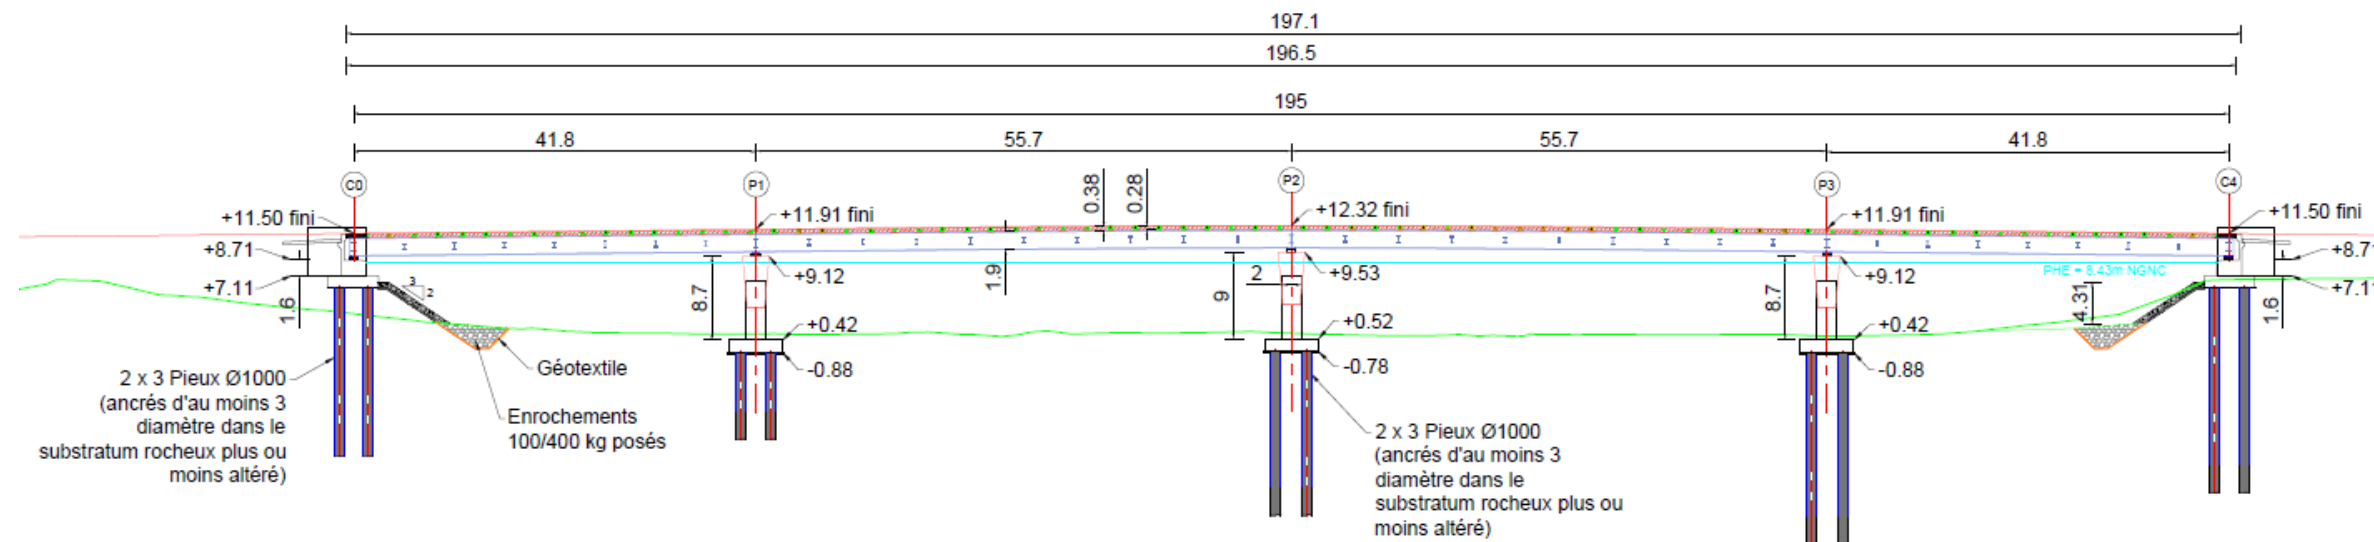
Coupe longitudinale du futur ouvrage d'art (source : APD - additif, Infratech)
